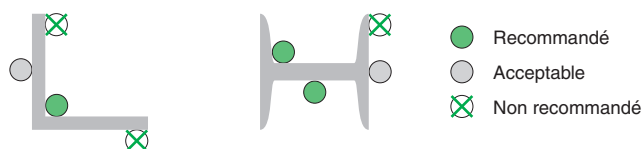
Recommandation pour l'installation de câbles sur poutrelles métalliques
